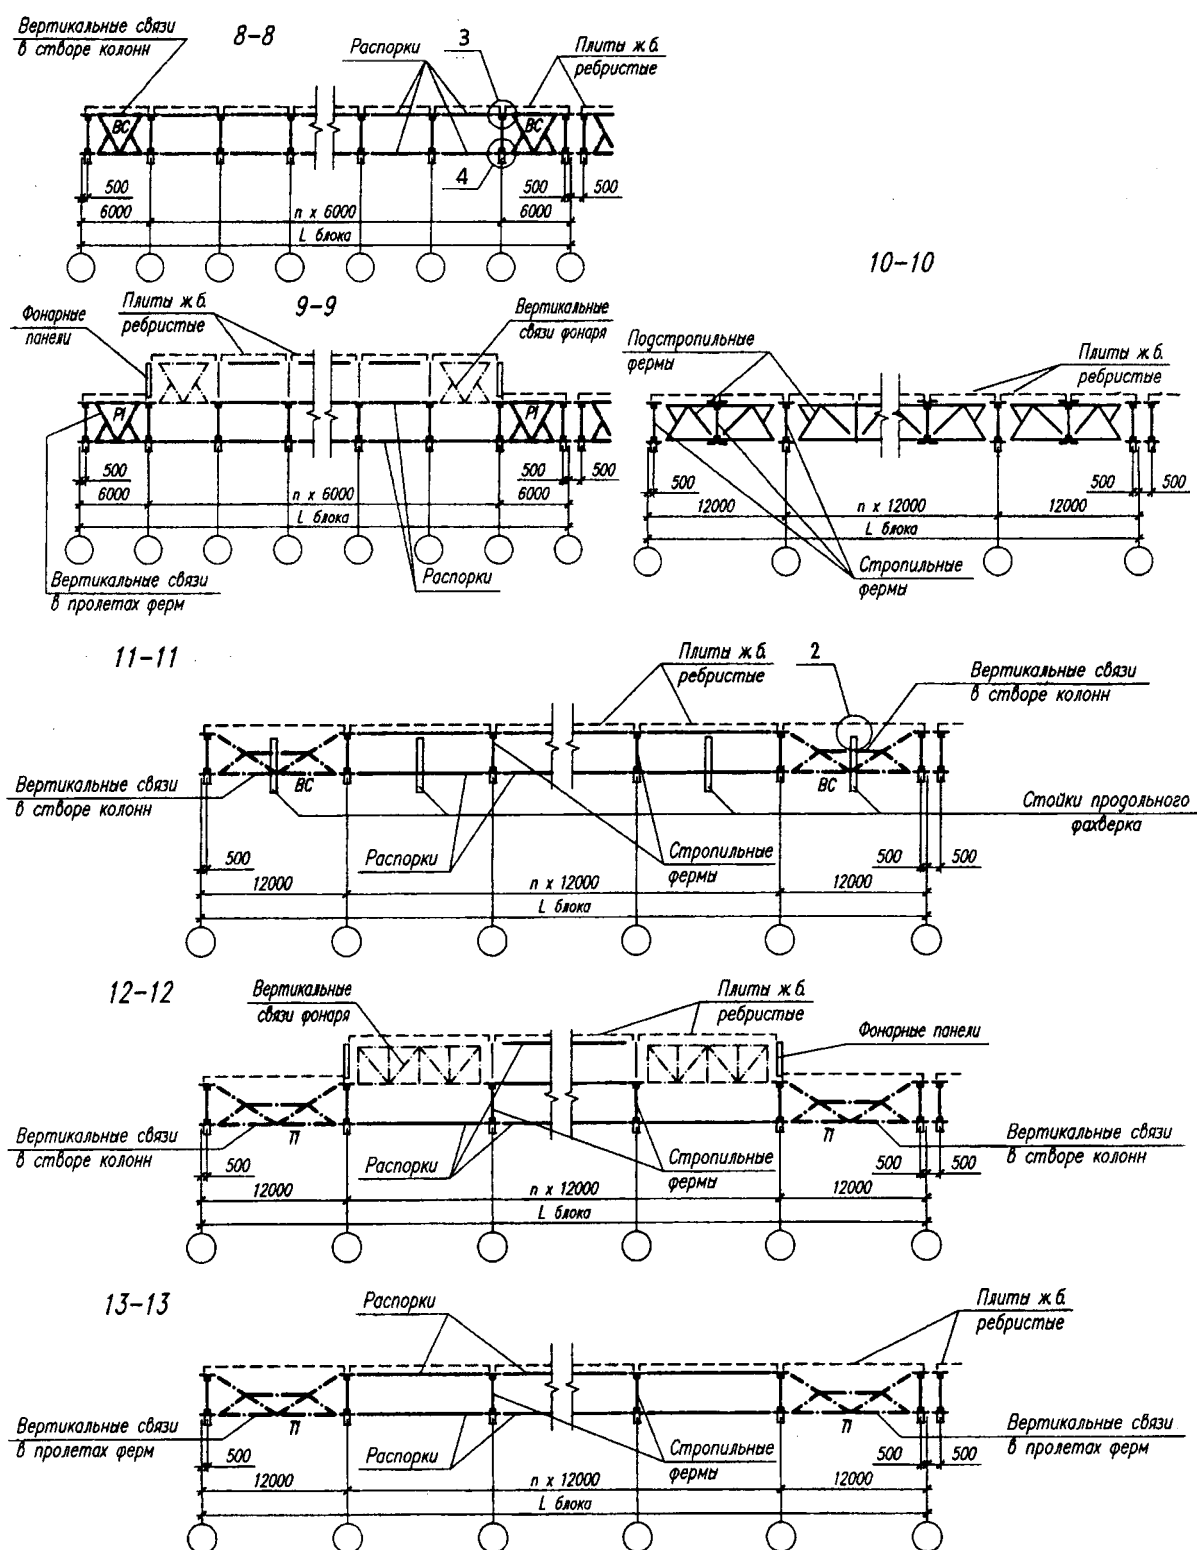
Схема расположения вертикальных связей в покрытиях с применением железобетонных плит (разрезы обозначены на рис. 5.6, 5.7)
